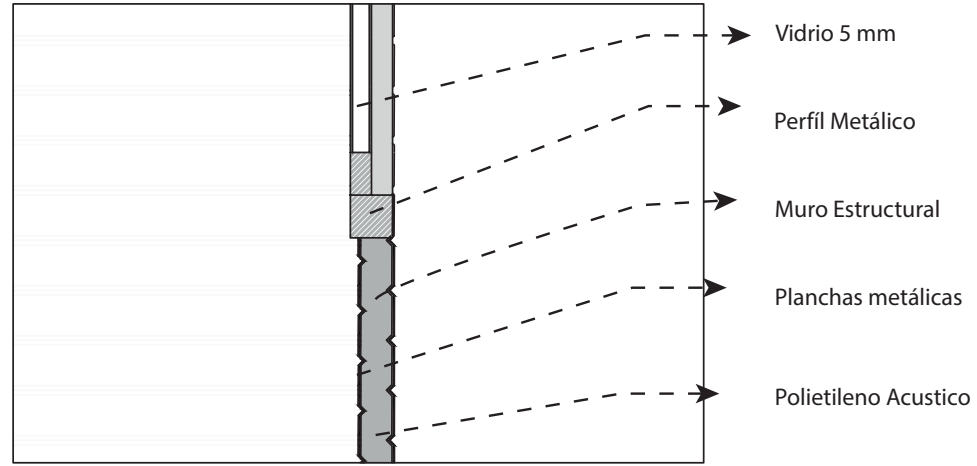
/ Detalle Constructivo Unión Piso Muro / Gráfico Propio
